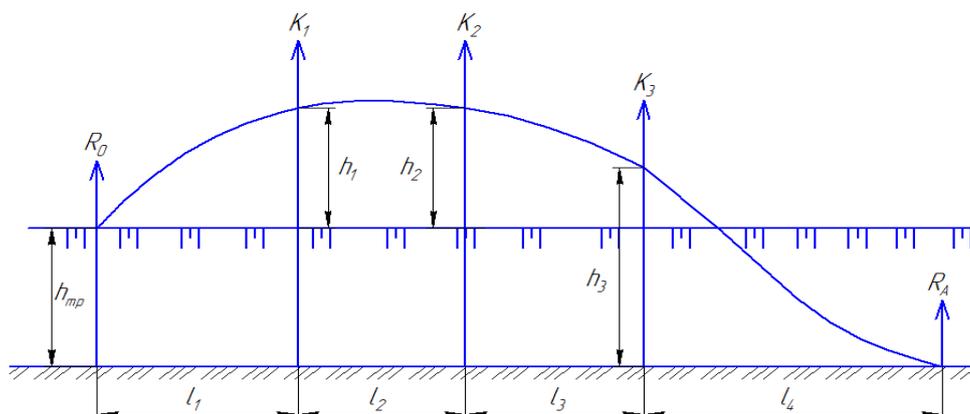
Расчётно-технологическая схема укладки трубопровода
